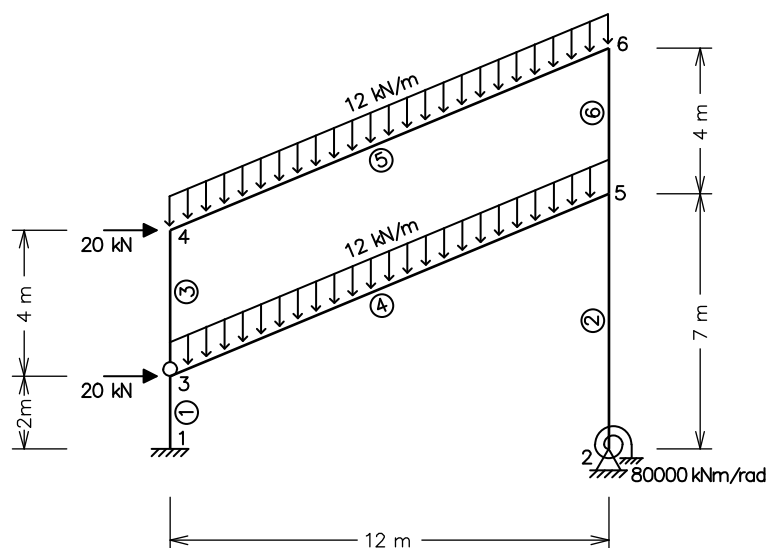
Pórtico plano com cargas nodais e cargas em barras.
